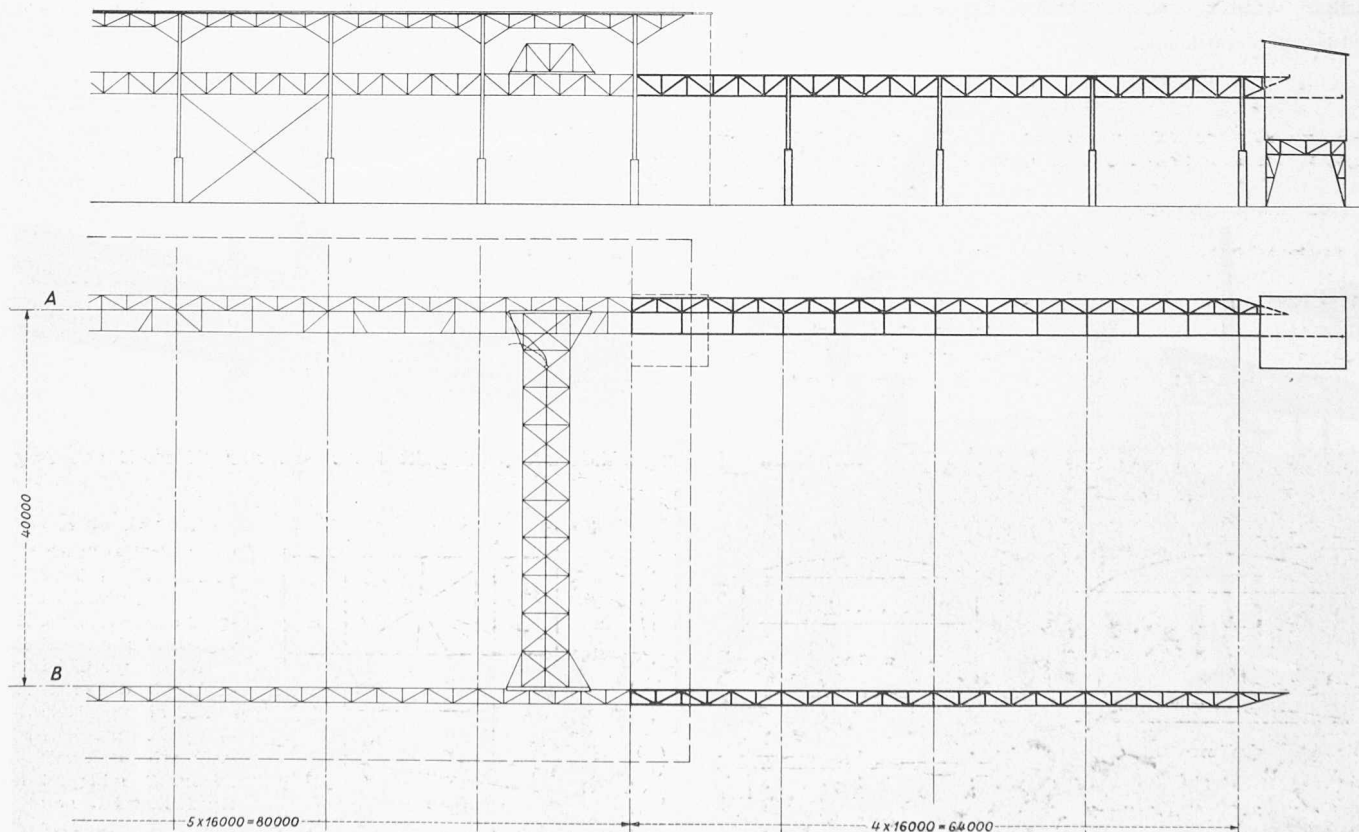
Grundriss und Längsschnitt 1:800 der Krananlage über dem Kokslager der Gaskokerei Kleinhüningen (Basel). Dünn = bestehend, kräftig = Erweiterung
